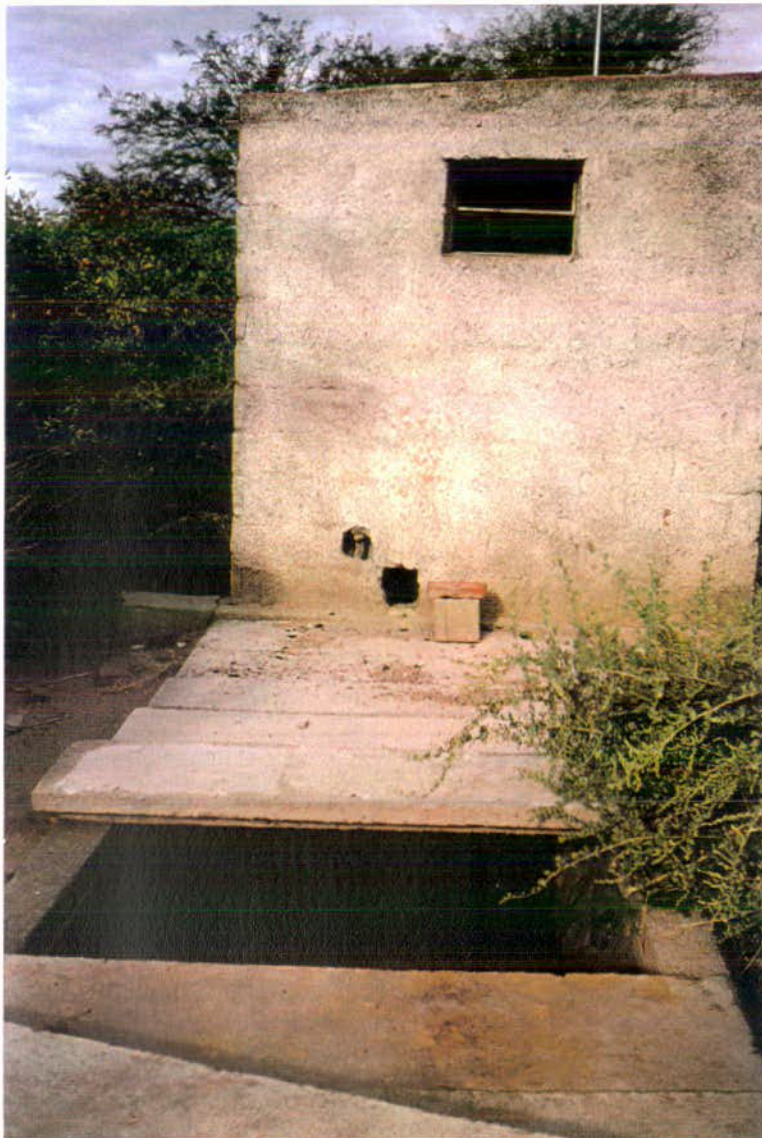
Vista del Canal Matriz de Riego al pasar por la sala de bombas de la planta potabilizadora. Puede apreciarse la falta de algunas losetas de hormigón que lo tapan a lo largo de su trayecto.
